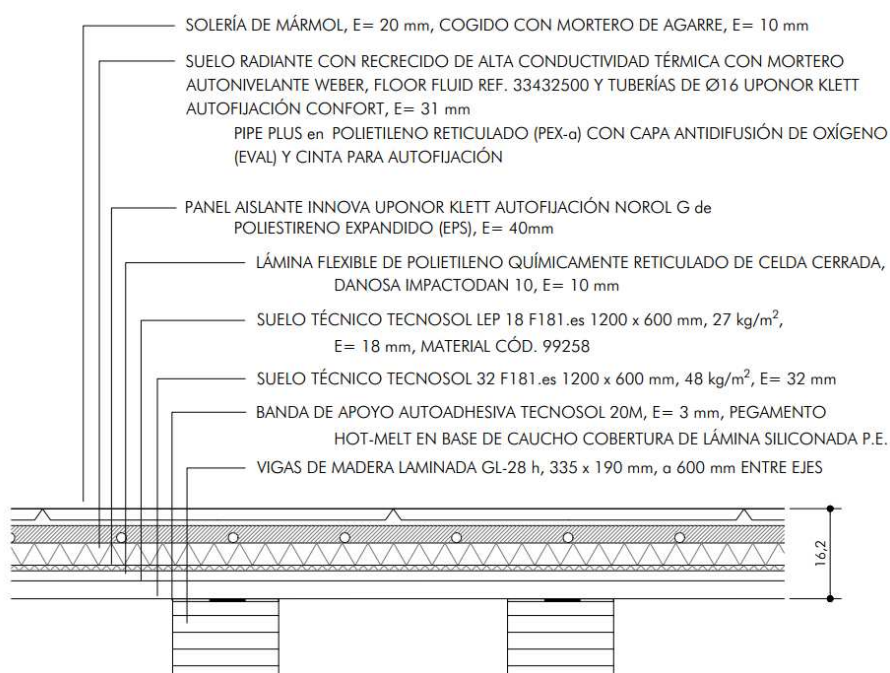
Sección constructiva zonas interiores de forjados de planta alta y cámaras
